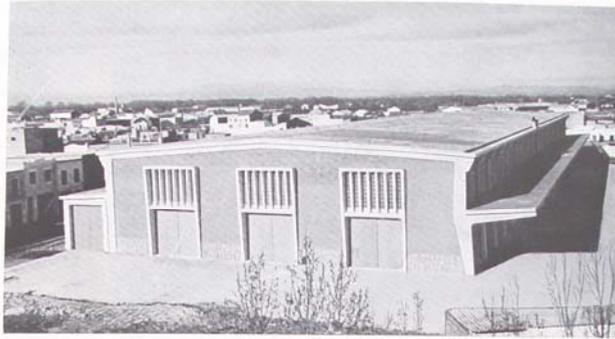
VUE D'ENSEMBLE DE L'ENTRÉPÔT.
